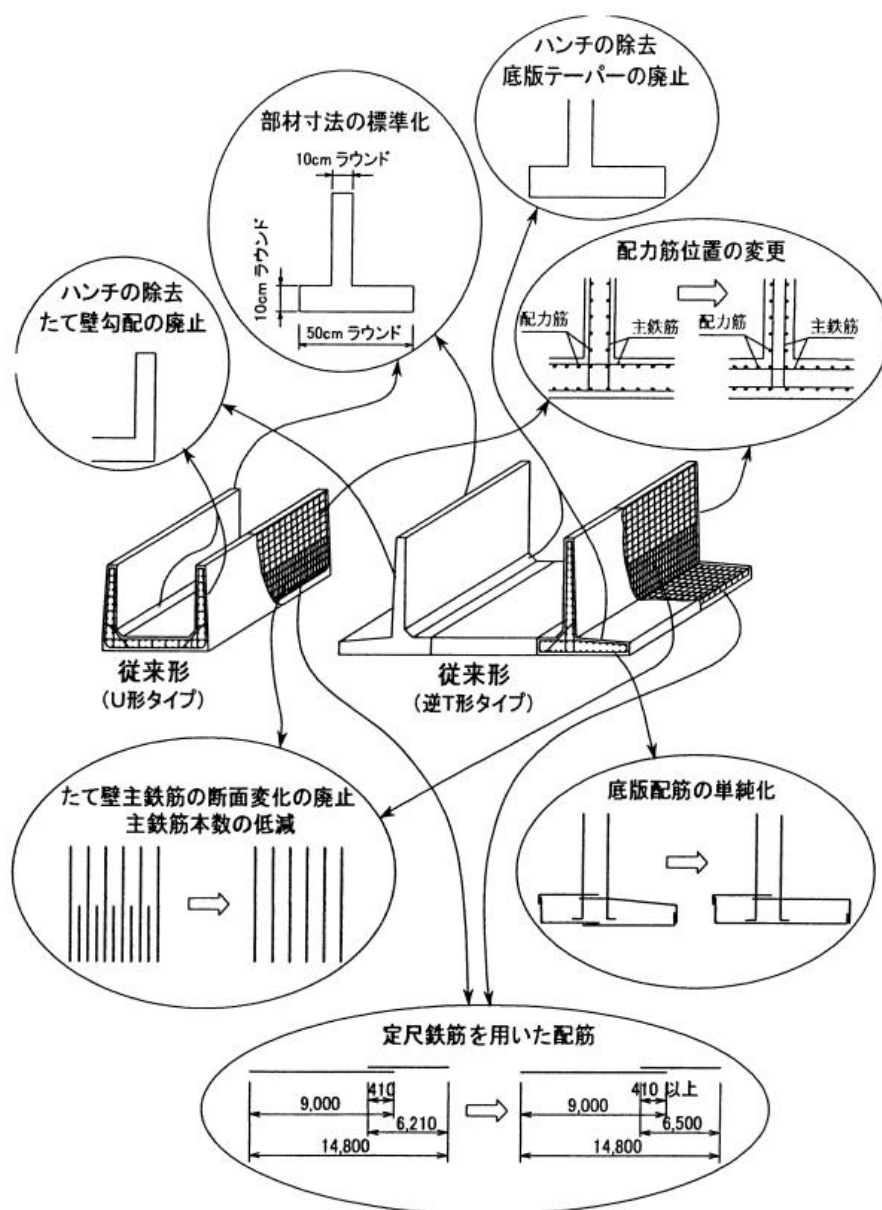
樋門の設計・施工合理化策の概要図 (翼壁)
